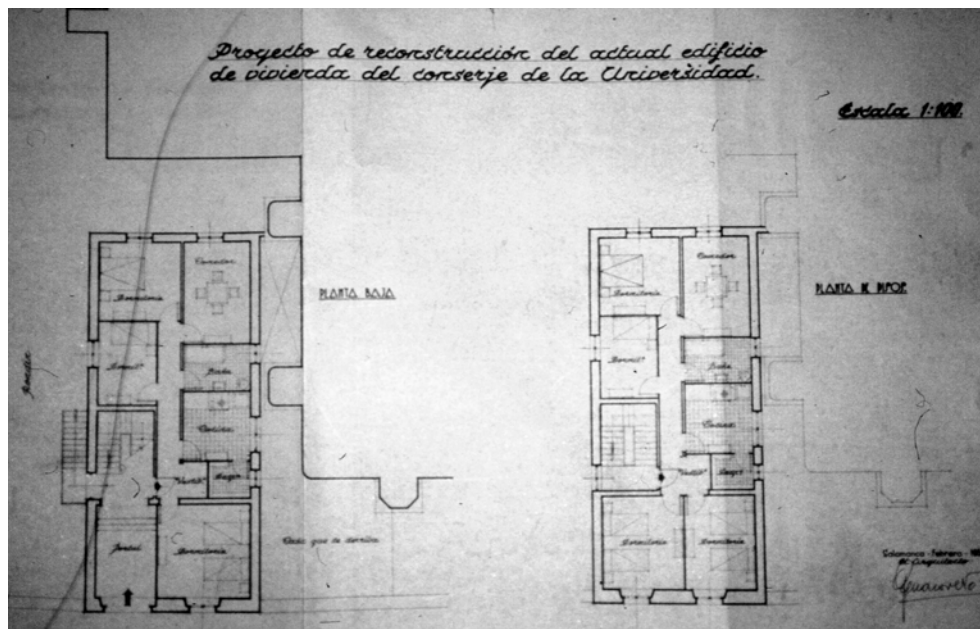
Vivienda del Secretario: planta baja y planta de pisos, por Genaro de No, febrero 1953.
